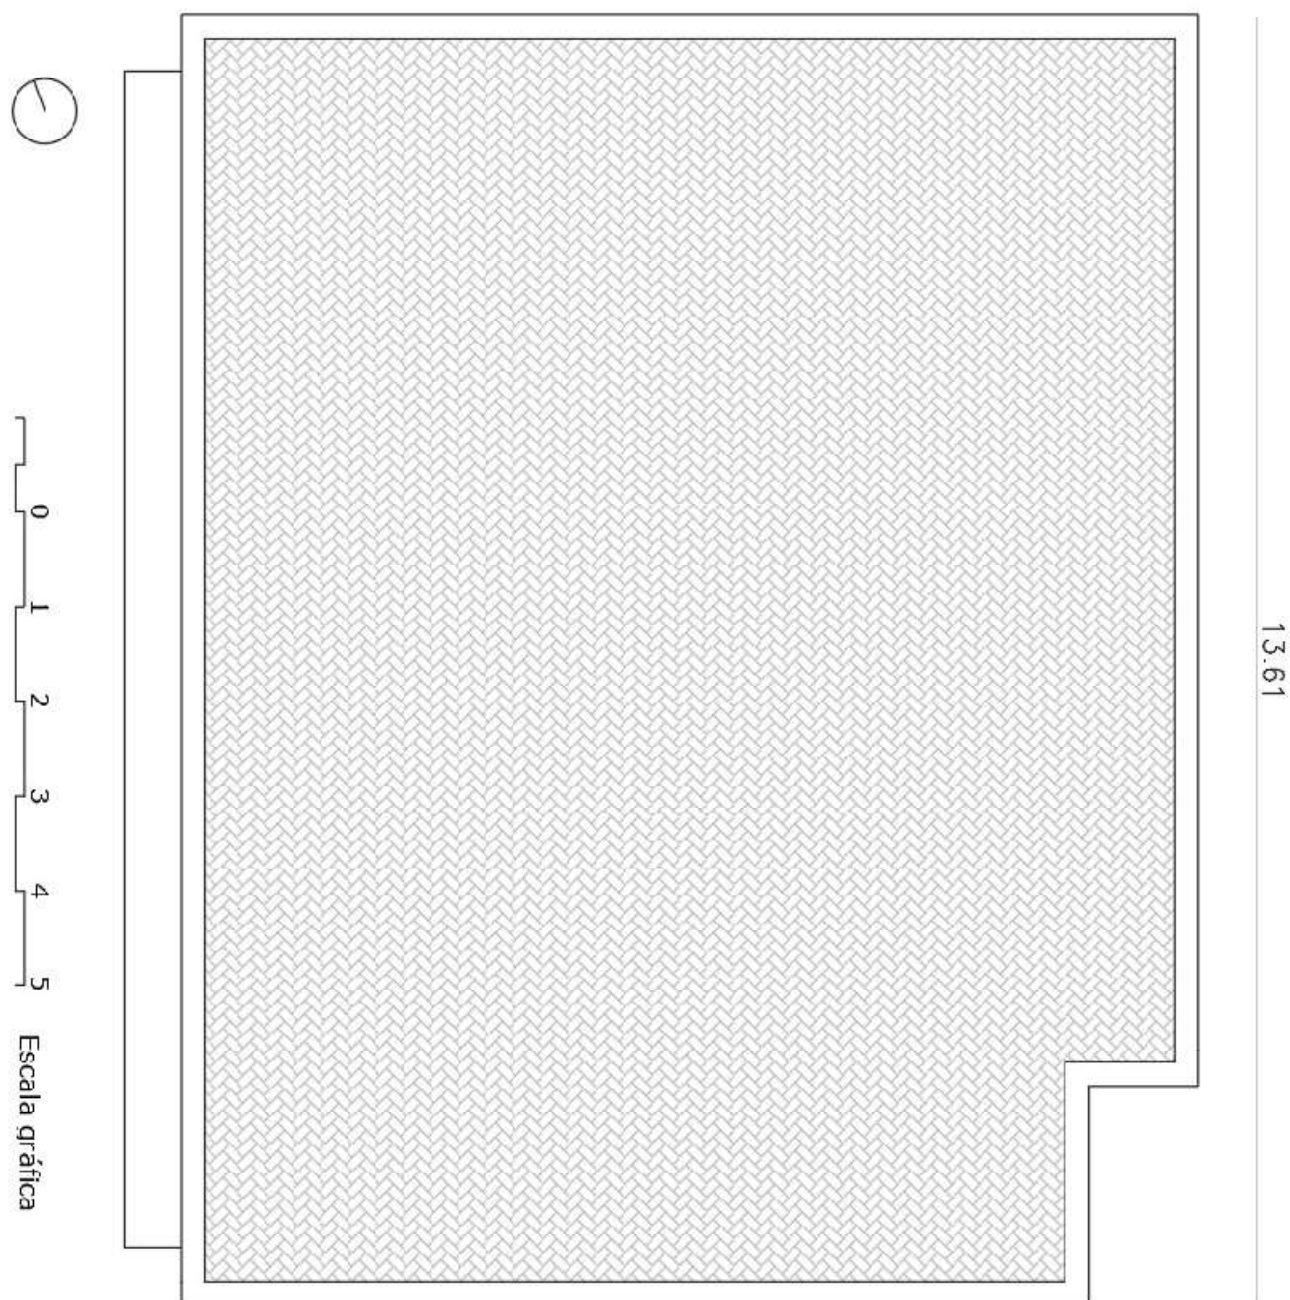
Planta de cubierta proyecto. (Elaboaración propia).
